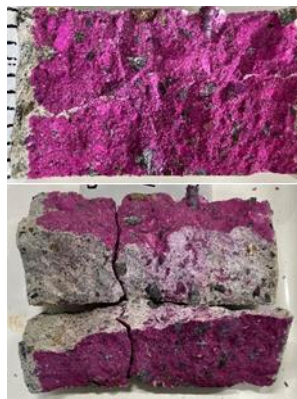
No.1 の中性化状況 (収縮ひび割れ)
